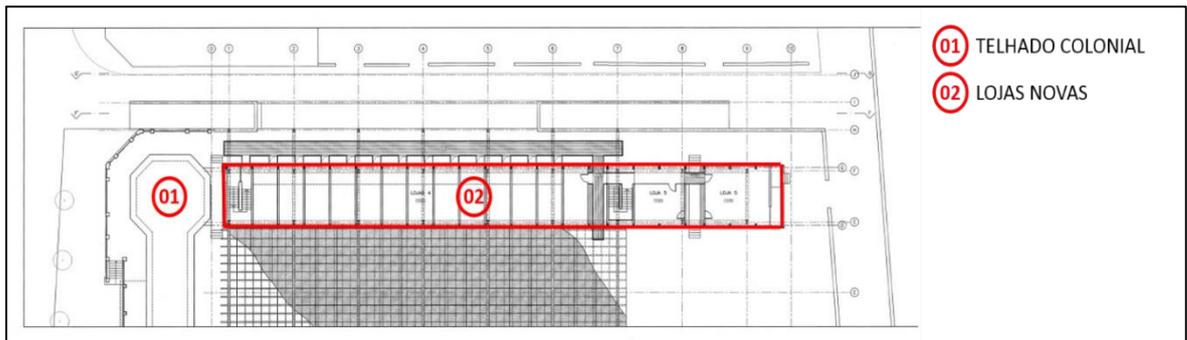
PLANTA BAIXA SEGUNDO PAVIMENTO
